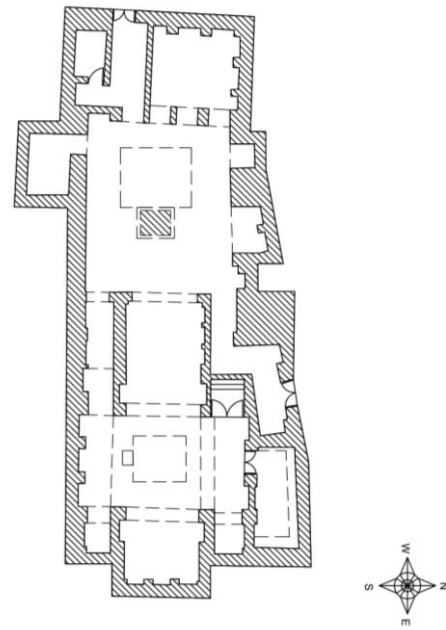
مسقط أفقي لكنيس أقا شكر الله
